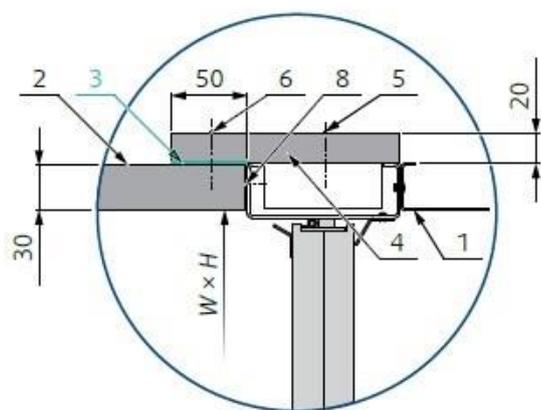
Sezione trasversale del collegamento con lastra della condotta di spessore 30 mm
